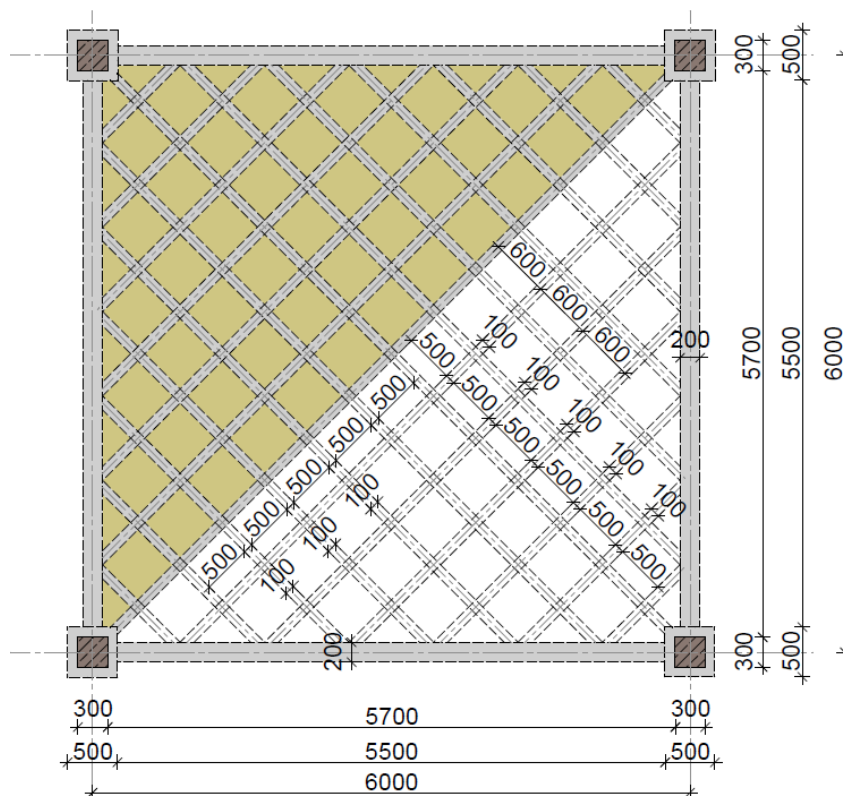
Переріз розглянутої плити перекриття (Варіант №1)
